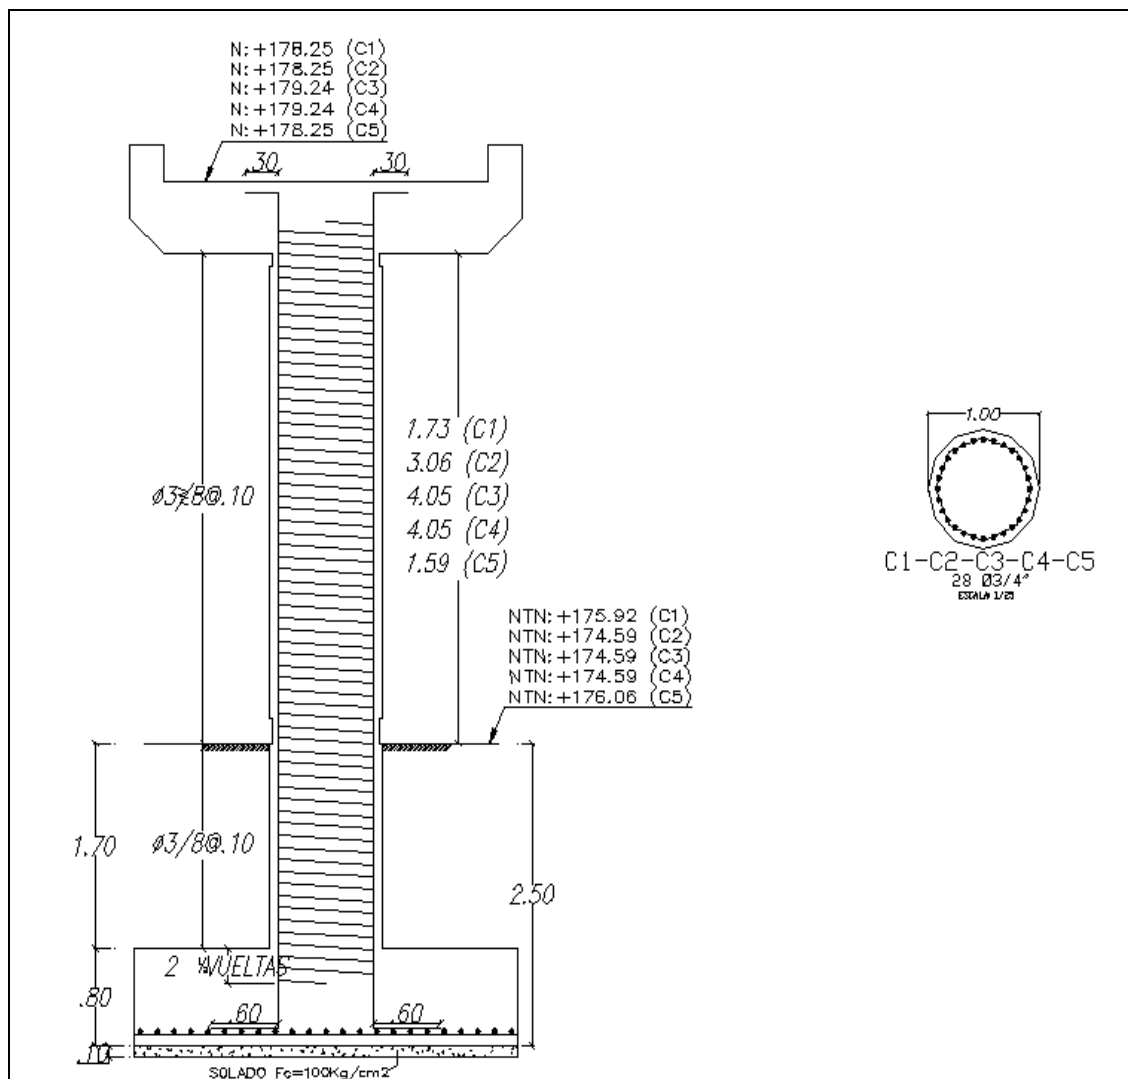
Detalle zapata y columna circular de los apoyos del proyecto definitivo del puente peatonal
